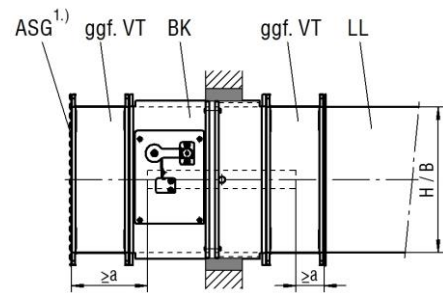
Esempio di collegamento aeraulico solo su un singolo lato e griglia di protezione.
